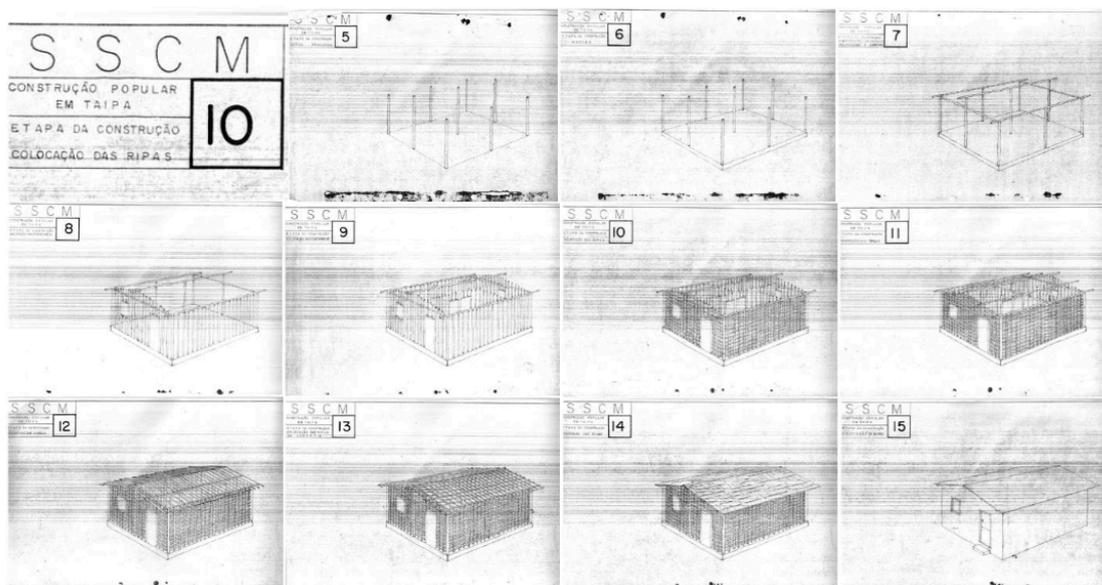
Isométrica casa Quincha Prefabricada. Fuente: Archivo Acácio Gil Borsoi.
